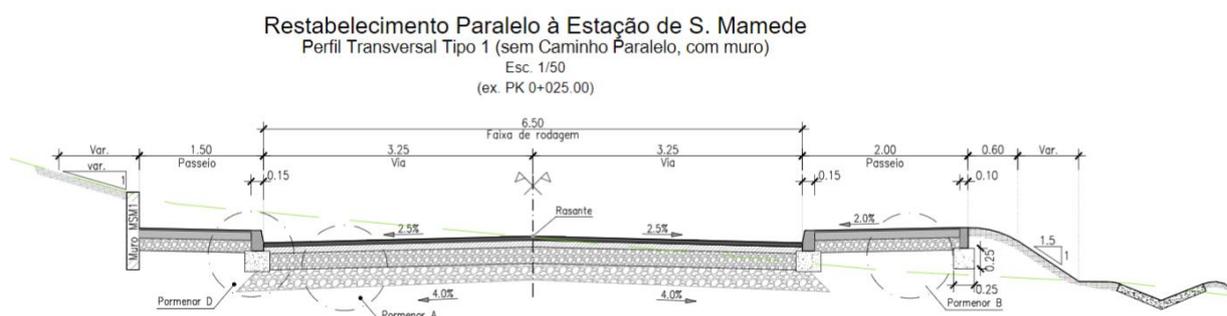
Perfil transversal tipo do restabelecimento paralelo à Estação de S. Mamede
